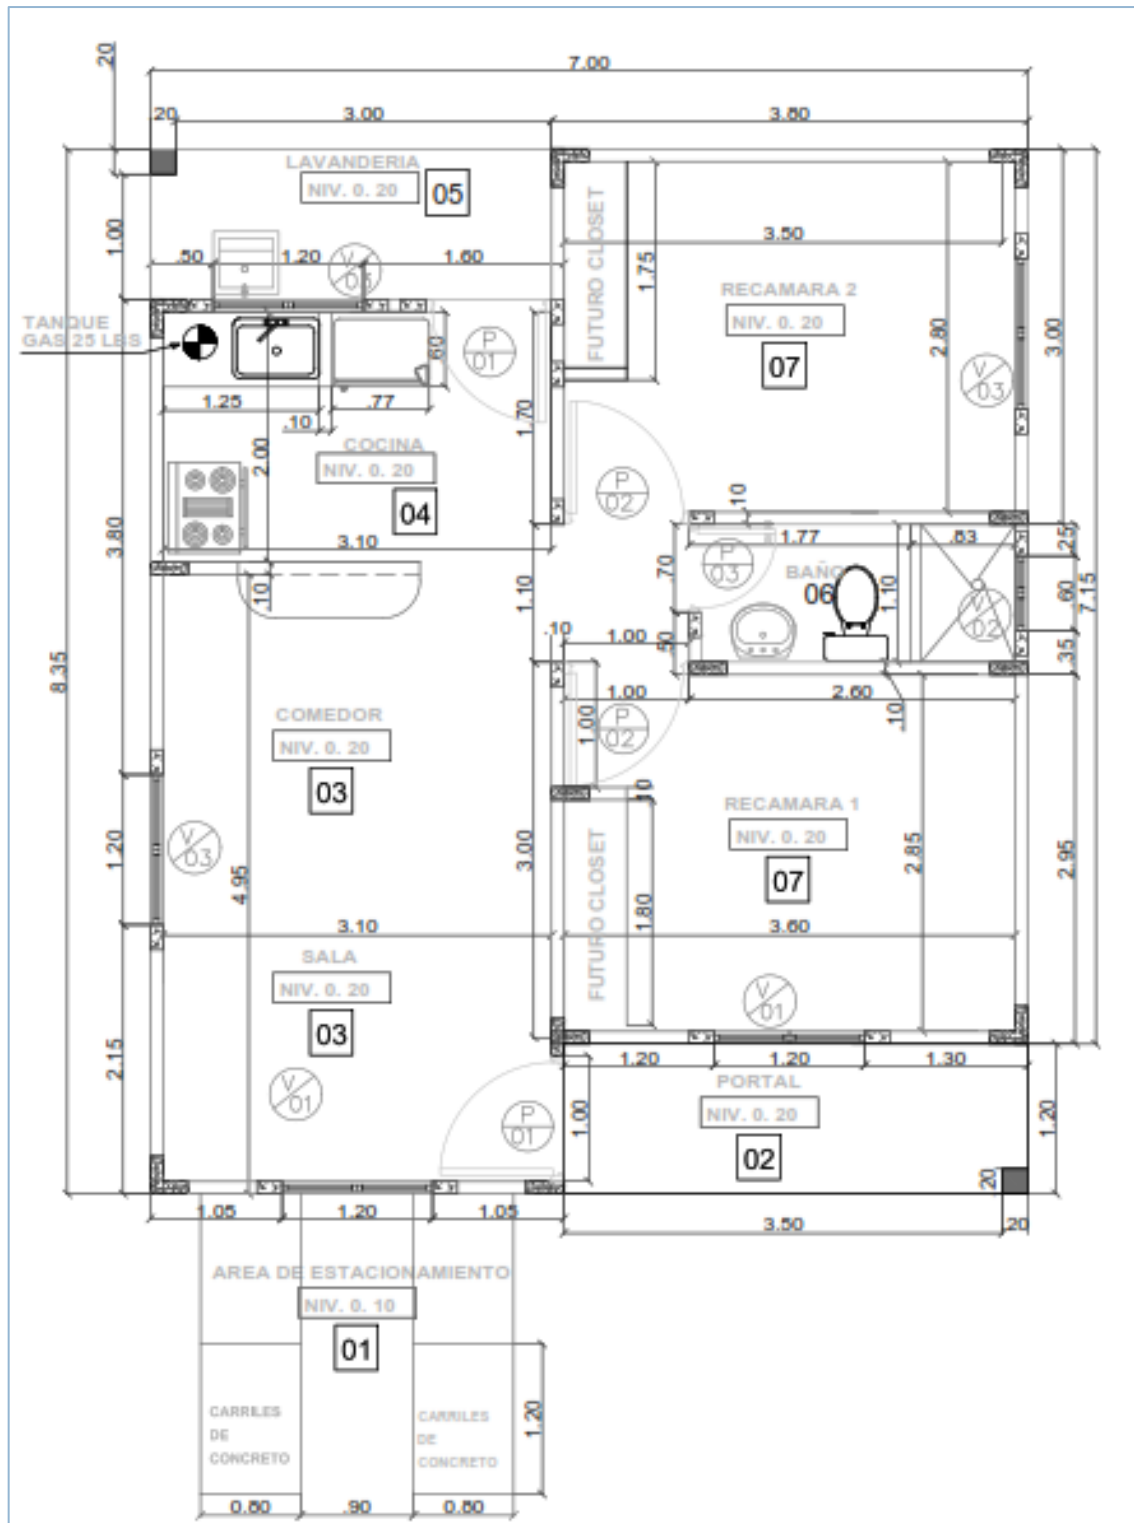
Planta arquitectónica de las casas. Fuente: Plano de anteproyecto
